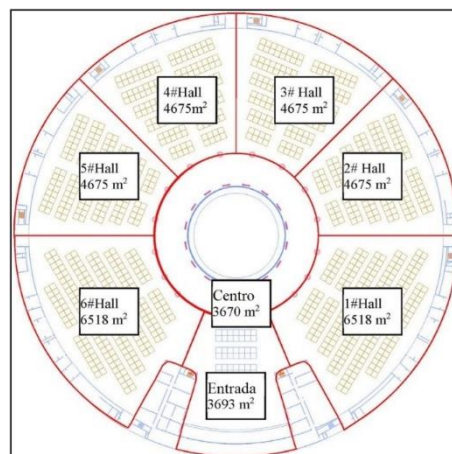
Planta e áreas das diferentes zonas do centro de exposições de Taiyuan (adaptado de [12])
